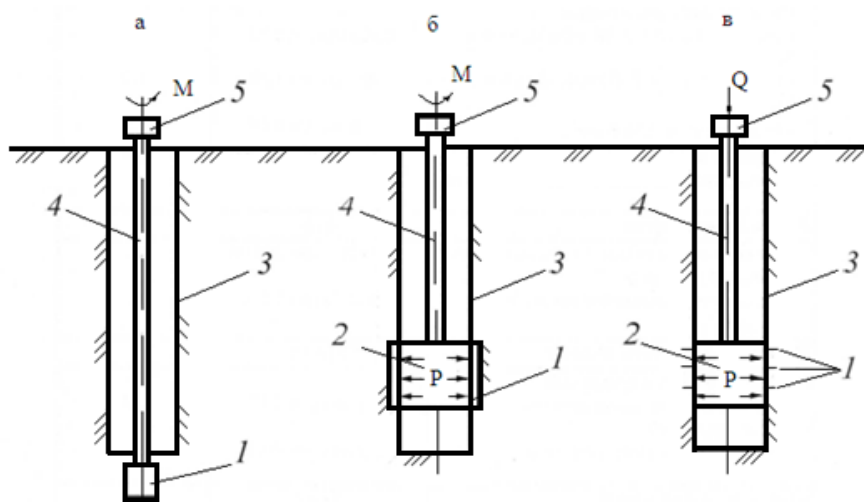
Схемы испытаний грунта в скважинах на срез:
